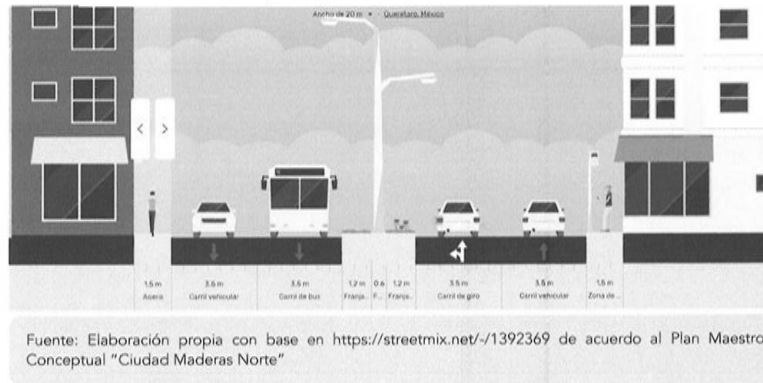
Calle de acceso principal con camellón del Plan Maestro Conceptual
